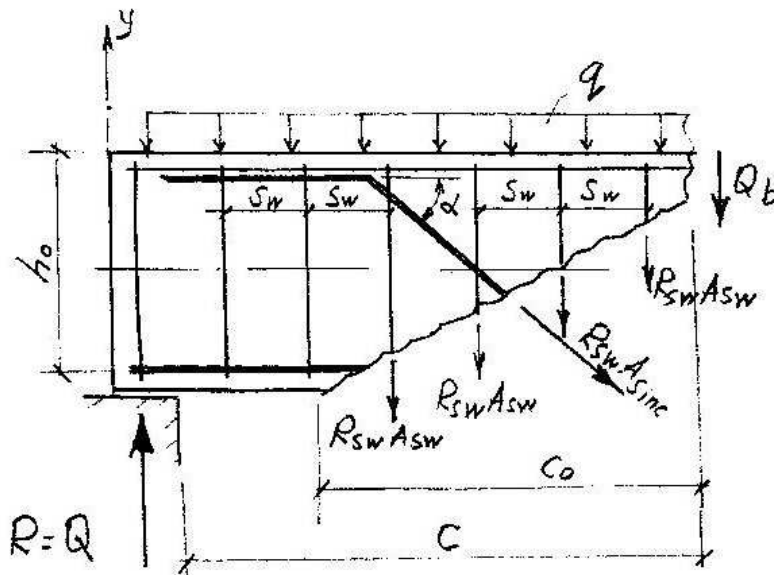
Схема внутрішніх зусиль у похилому перерізі
